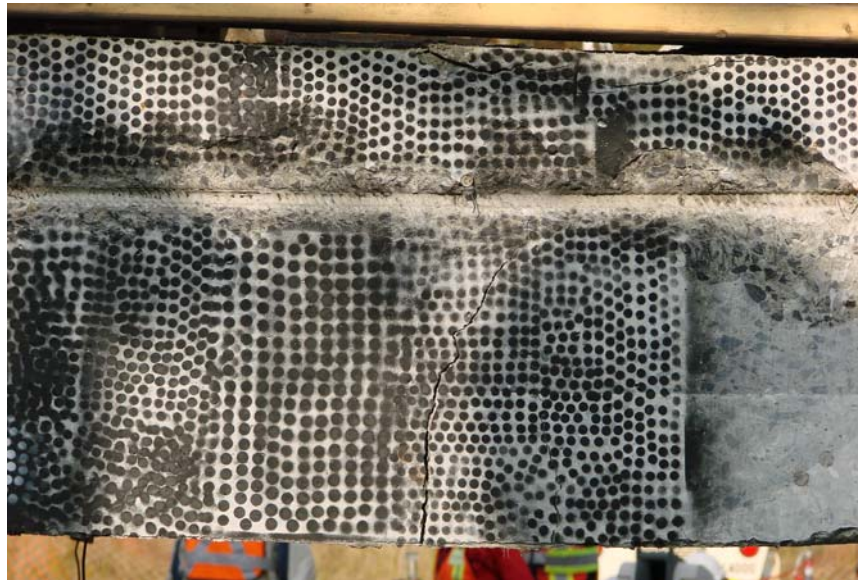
Fissures de flexion sur la face Ouest de la dalle
